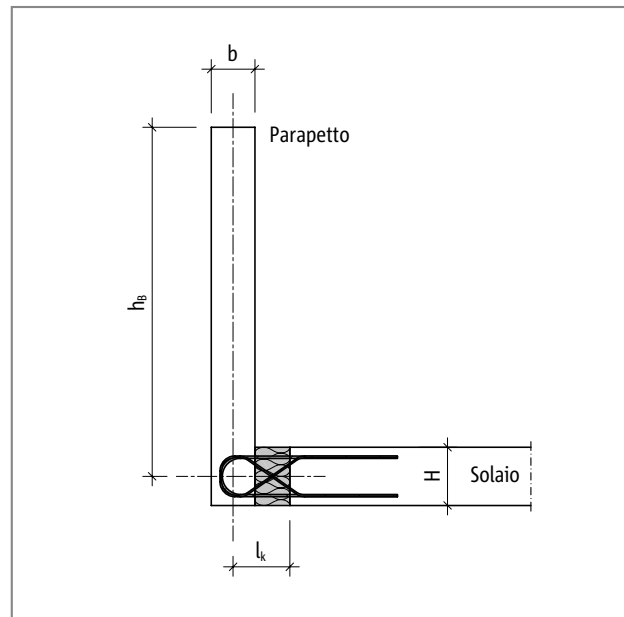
Schöck Isokorb® tipo ABXT, schema statico con altezza del parapetto  $h_B$
